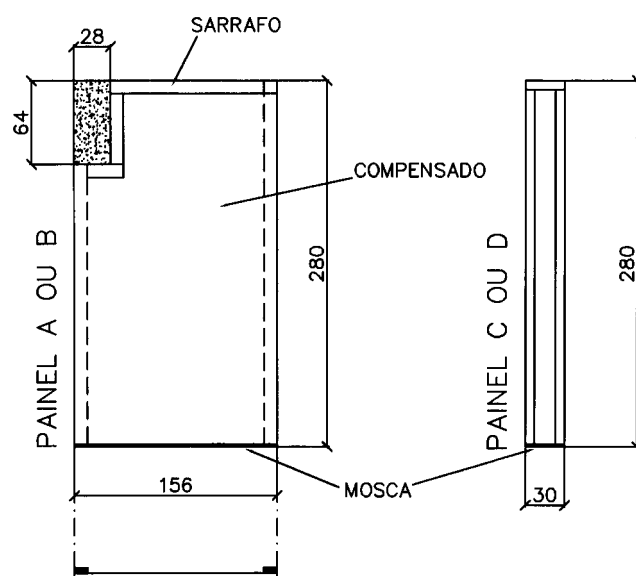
Detalhe das faces "lisa" dos painéis de pilar (medidas em cm).
